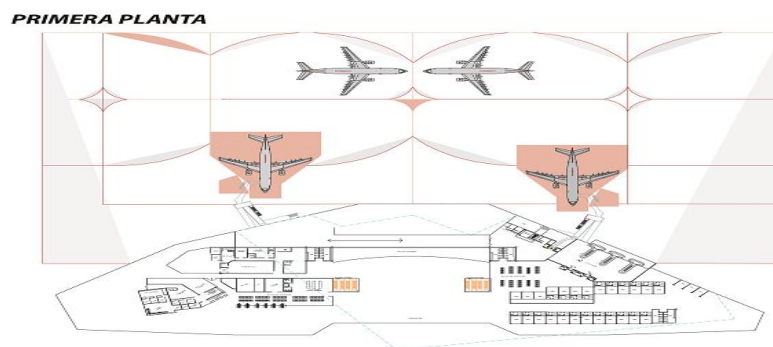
Plano desarrollo propuesta general sketch.
